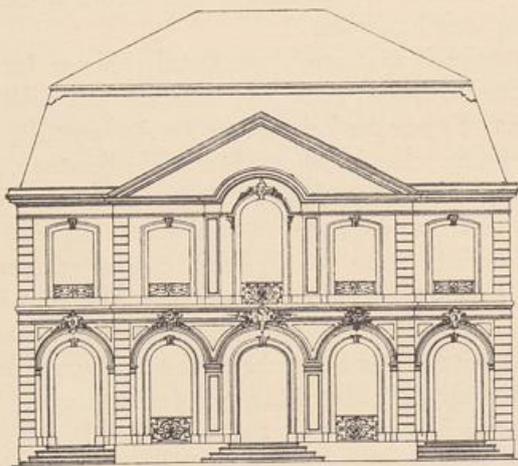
J. J. Couven. Originalentwurf der Fassade der ehemaligen „Acht“ auf dem Chorusplatz zu Aachen. Vgl. Grundriß und Schnitt Abb. 135.
